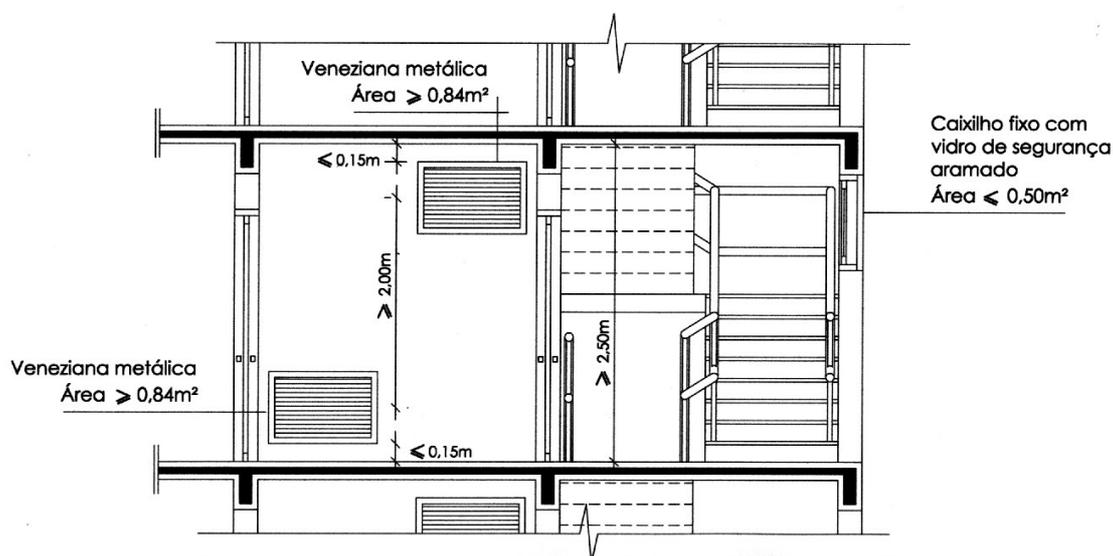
Corte esquemático da escada enclausurada à prova de fumaça da Figura 86.
